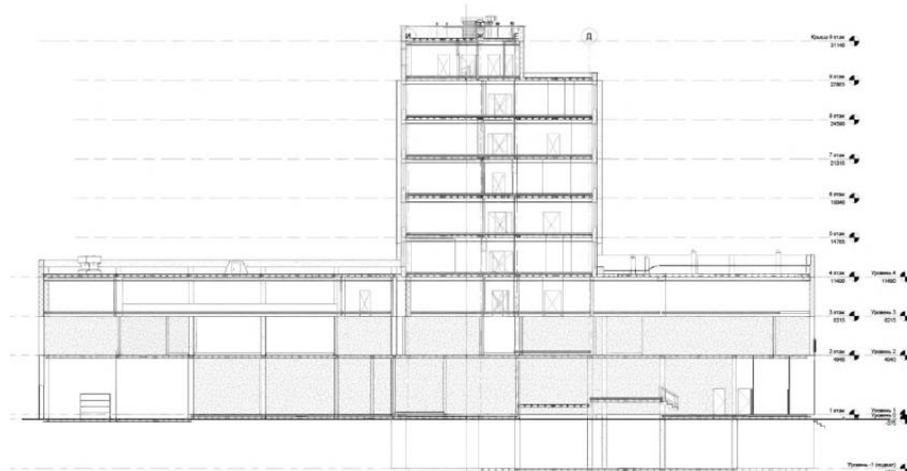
Поперечный разрез учебного корпуса УГНТУ №12.
